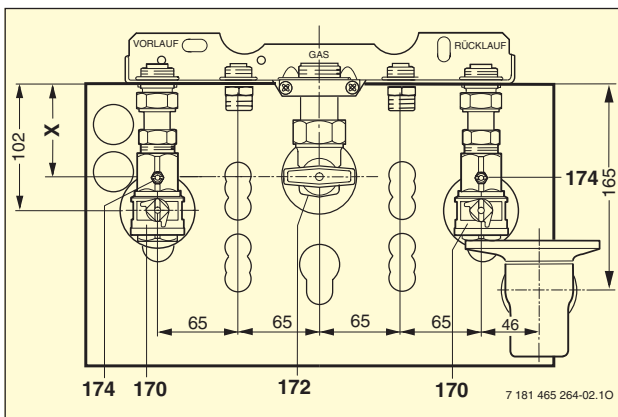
Montageanschlussplatte mit Unterputz-Installation (fertig montiert)
